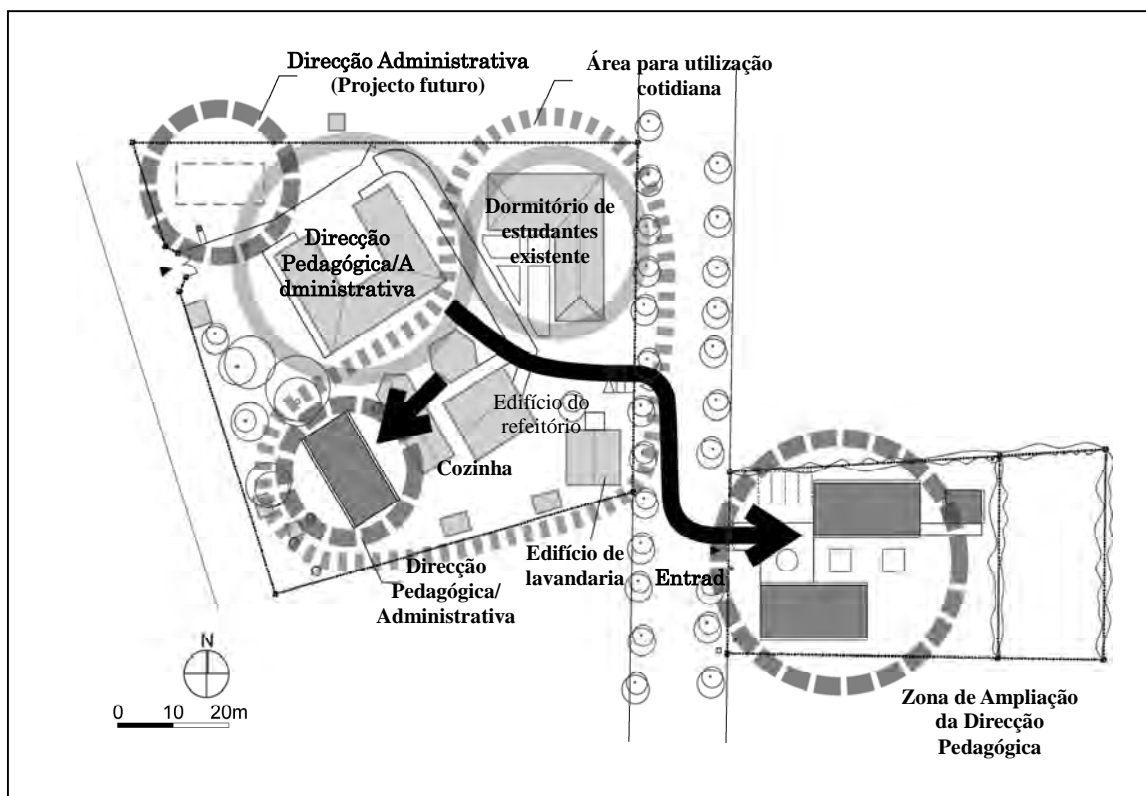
Plano de estudo do terreno e da disposição das instalações do CFS Massinga
